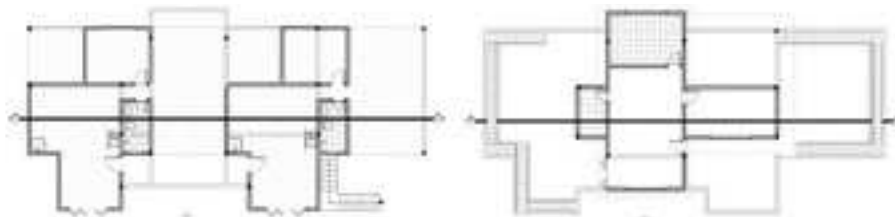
Planta baixa geminada do pavimento térreo e superior com os pátios laterais (0 a 3 S.M.)
